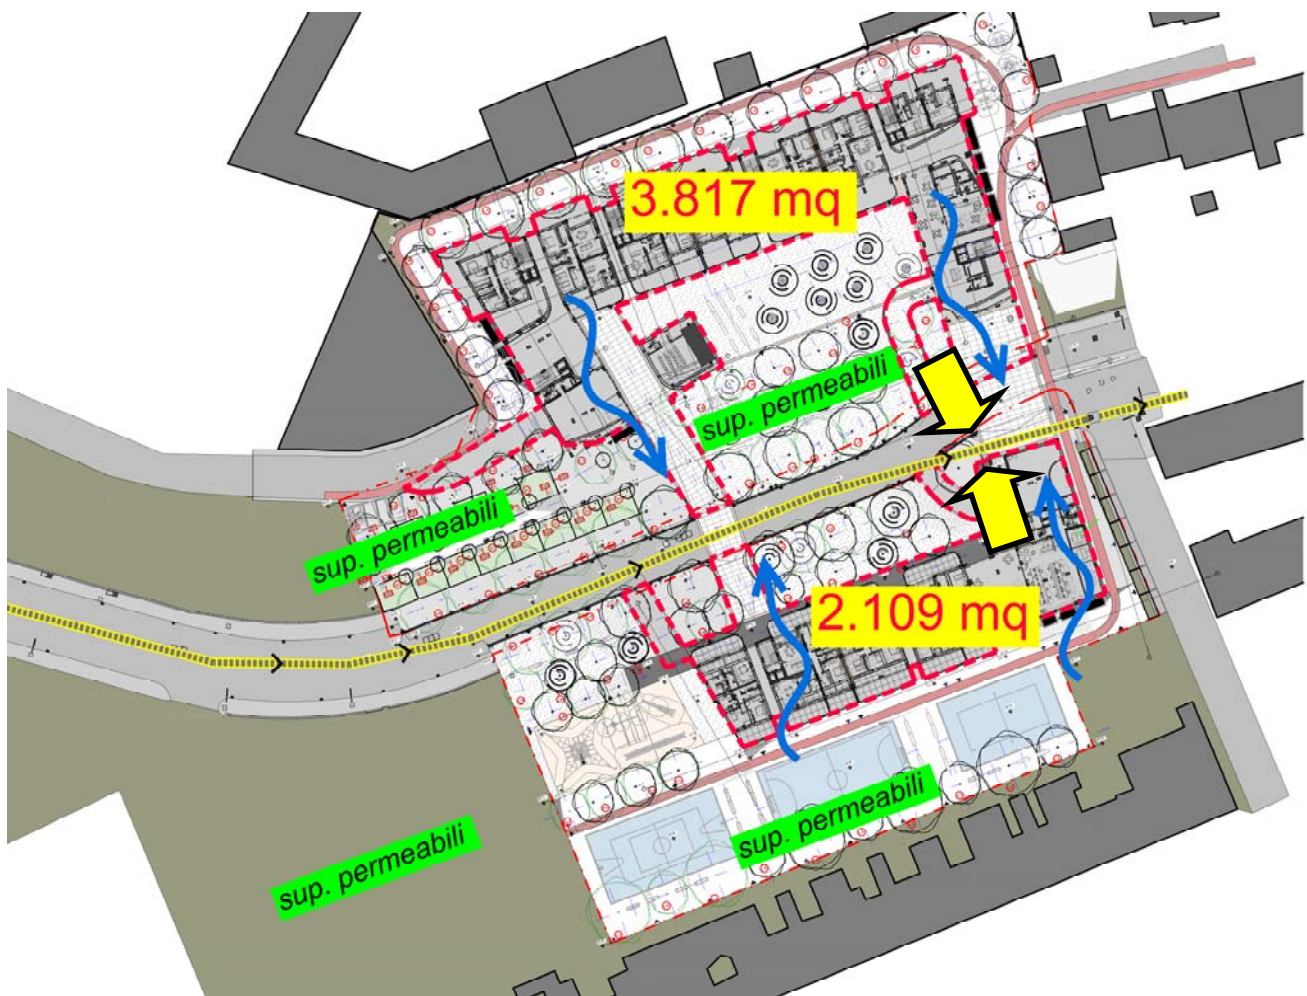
planimetria di progetto: SUPERFICI COMPLETAMENTE IMPERMEABILI
